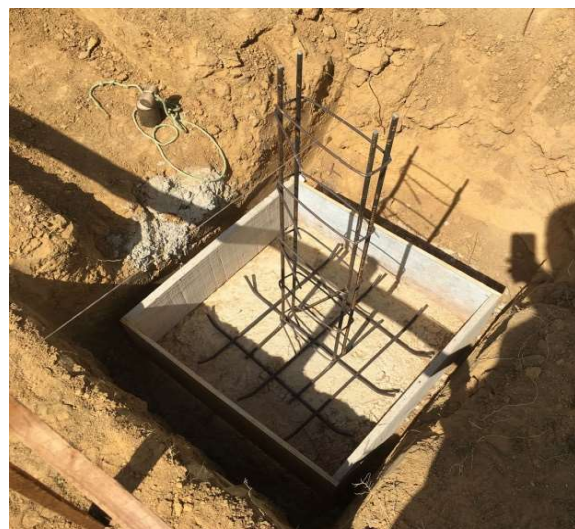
CONCRETO ARMADO PARA FUNDAÇÕES - SAPATAS.
